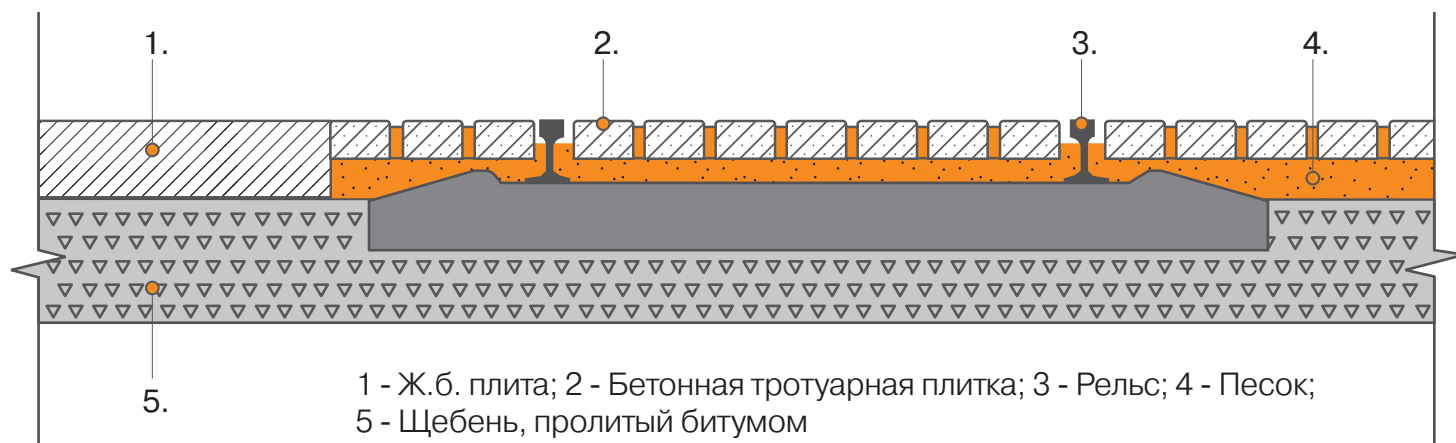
Конструктивная схема трамвайных путей с покрытием из плит бетонных тротуарных Группы В1
